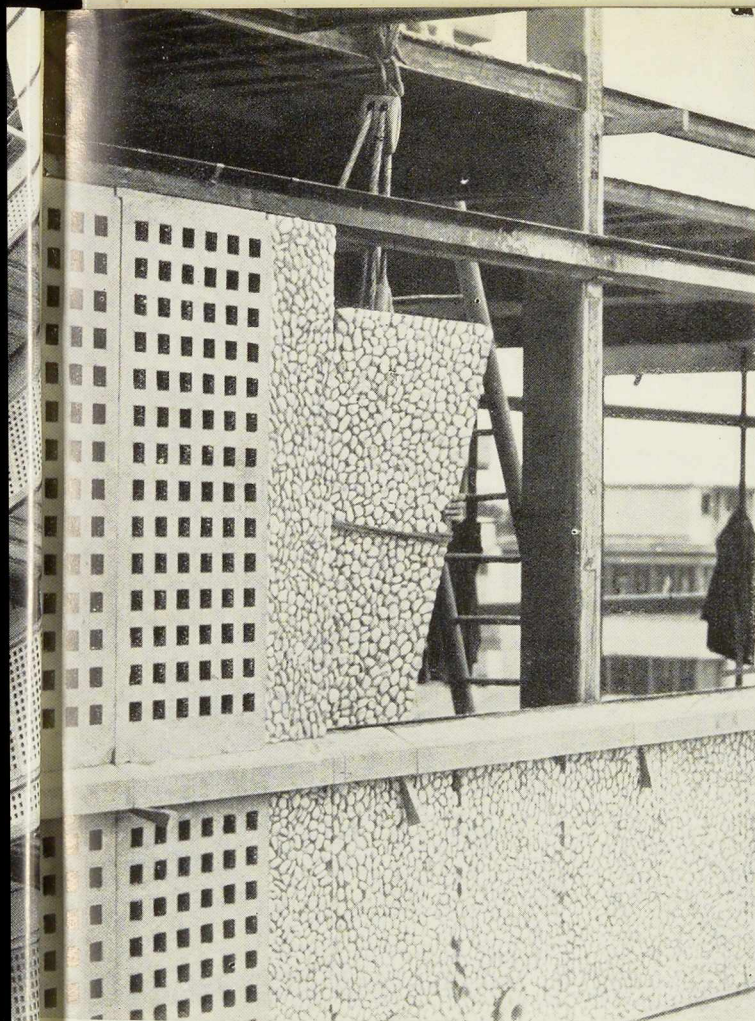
L'ossature achevée reçoit d'abord les planchers puis les murs extérieurs.
